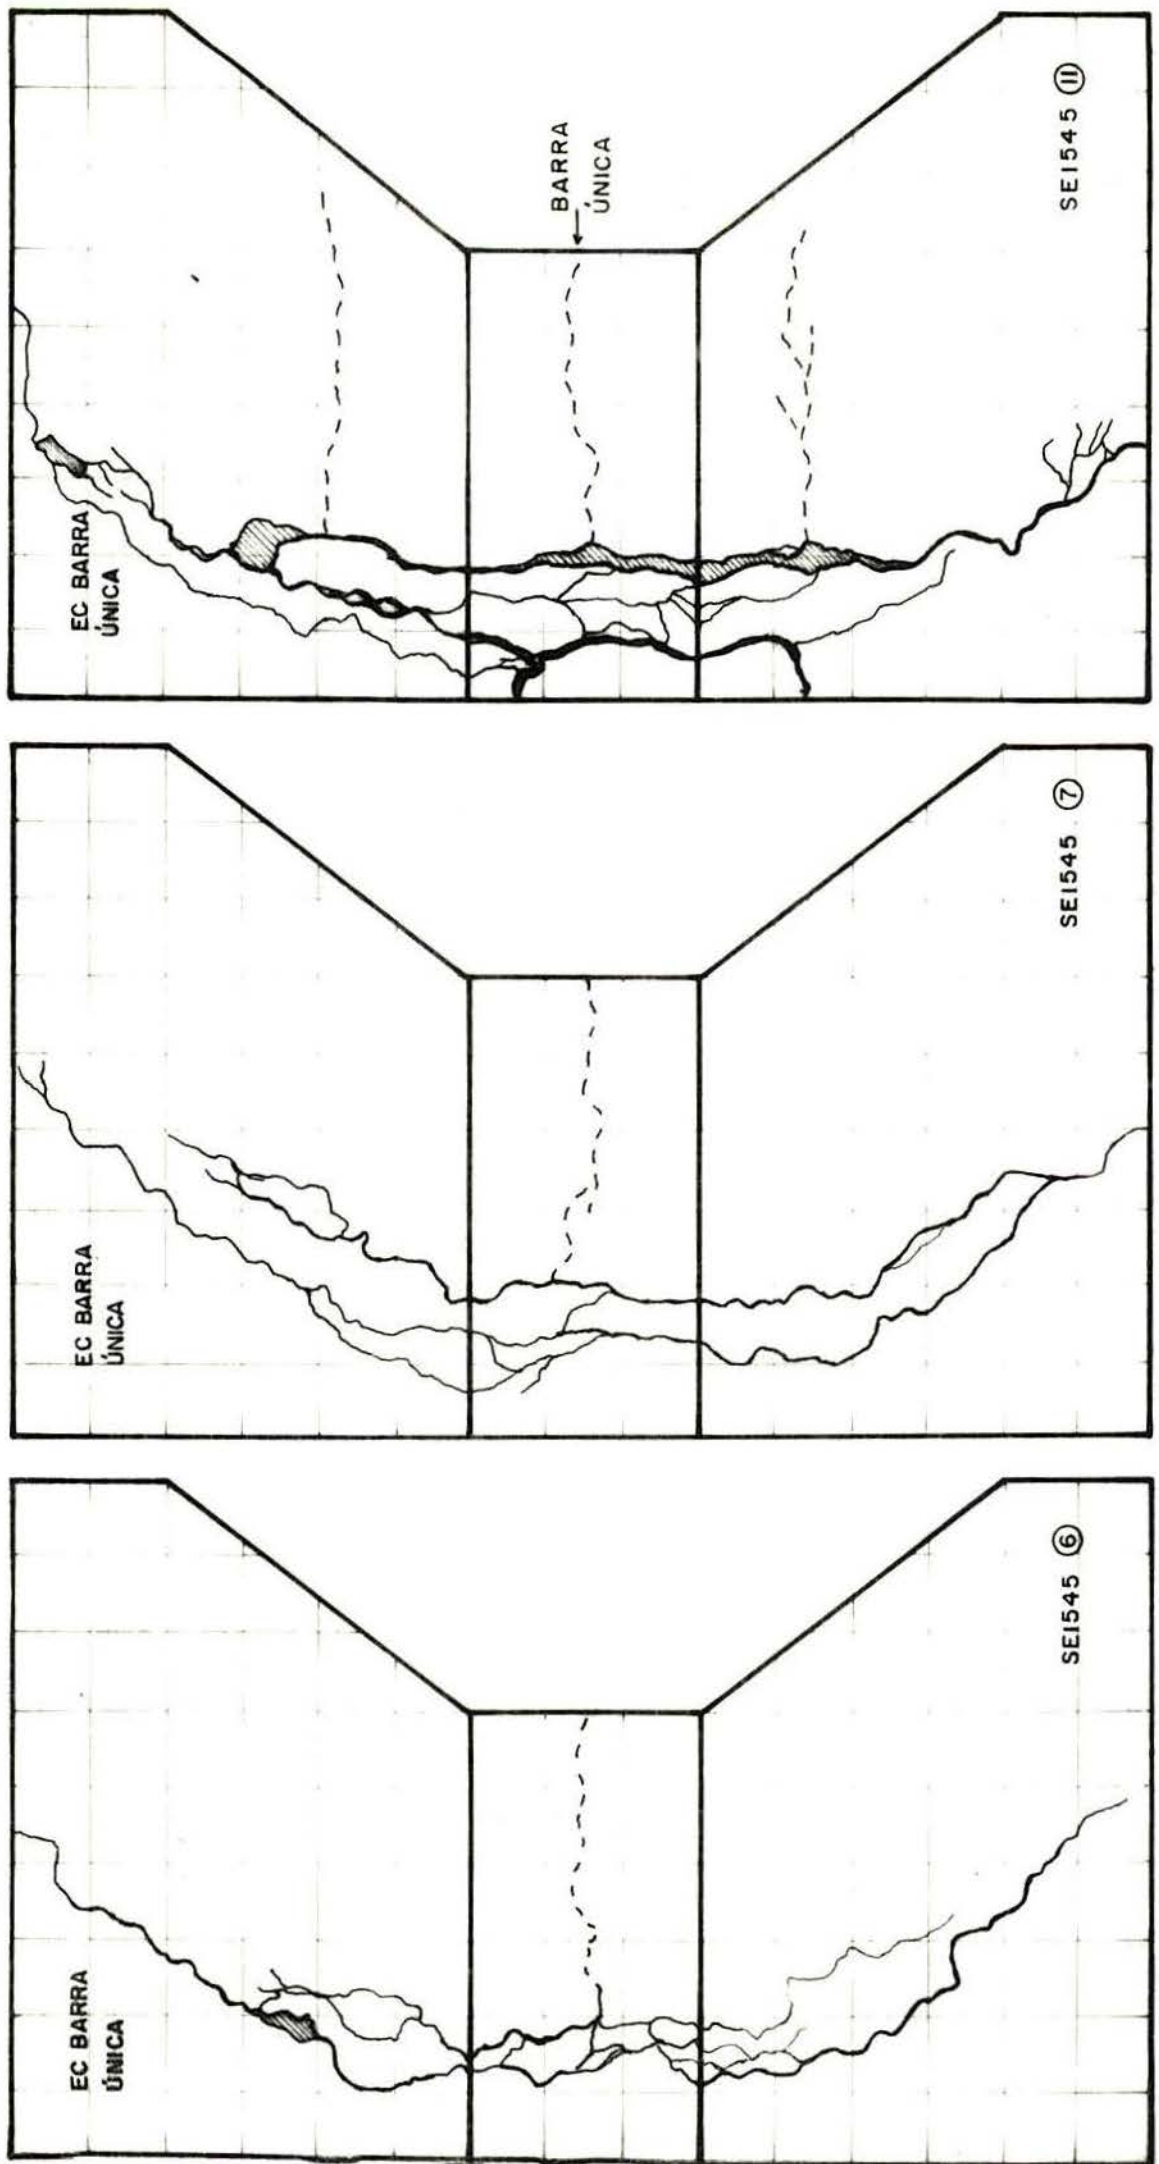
Fissuração dos CP SEI545
